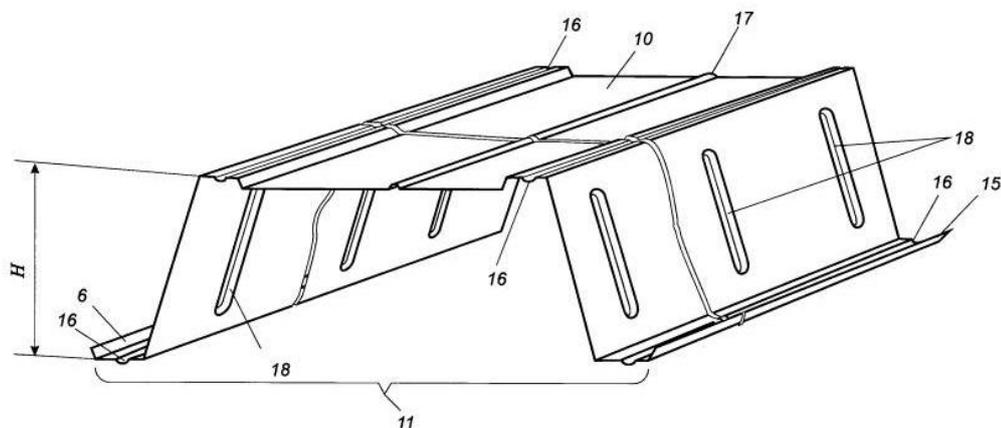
Опалубочный элемент несъемной опалубки большепролетного перекрытия
